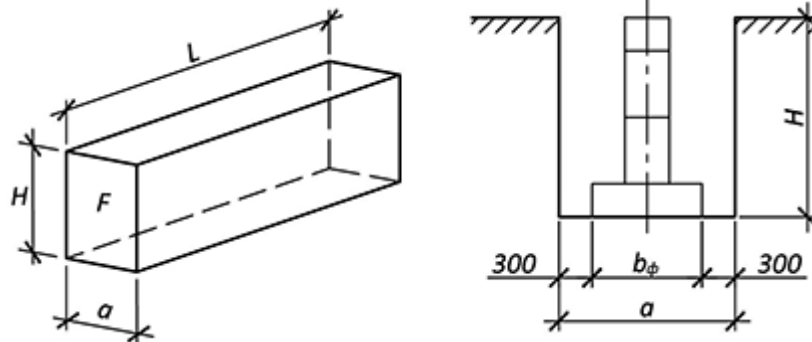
Траншея с вертикальными стенками на спланированной местности
